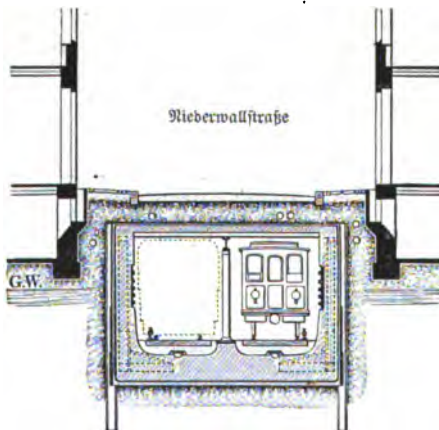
Tunnel der Berliner Untergrundbahn in der Niederwallstraße.
